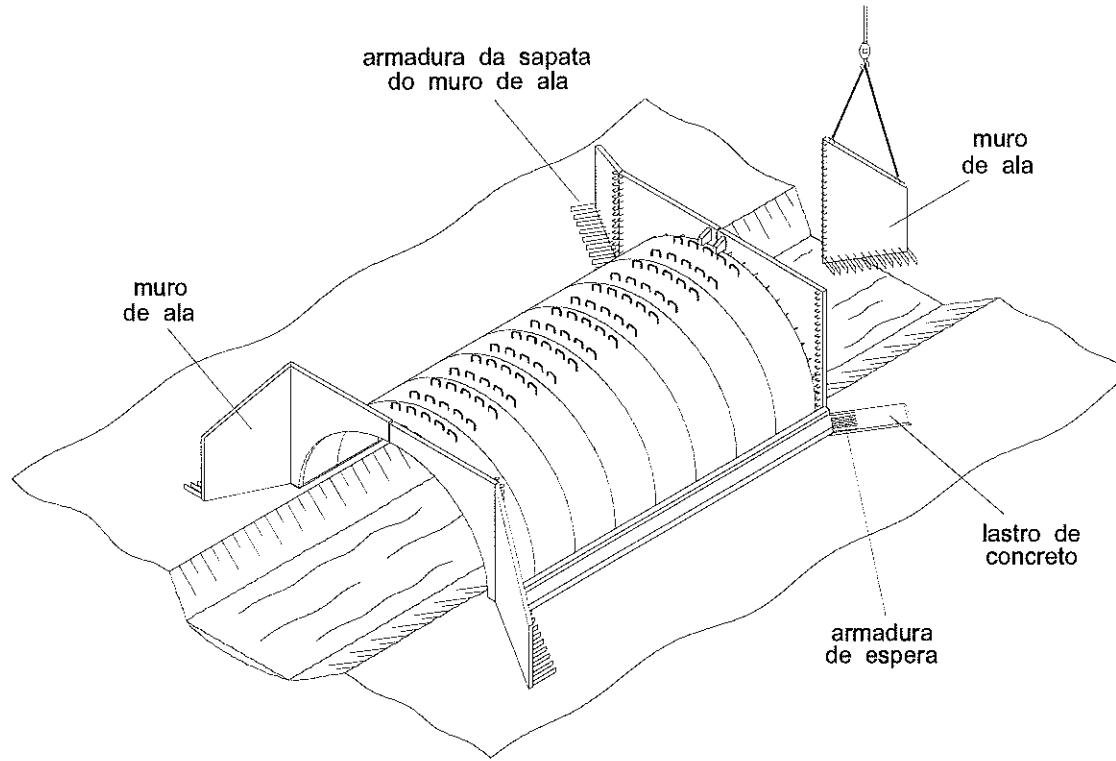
Colocação dos muros de ala apoiados no lastro de concreto e escorados nos muros de testa
